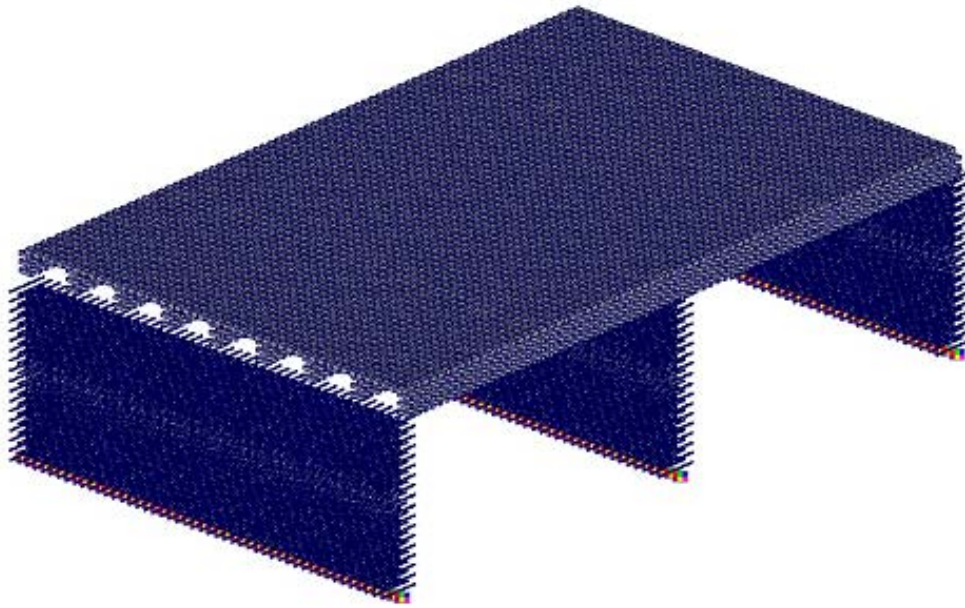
Расчетная схема перекрытия для расчета в ПК SCAD
